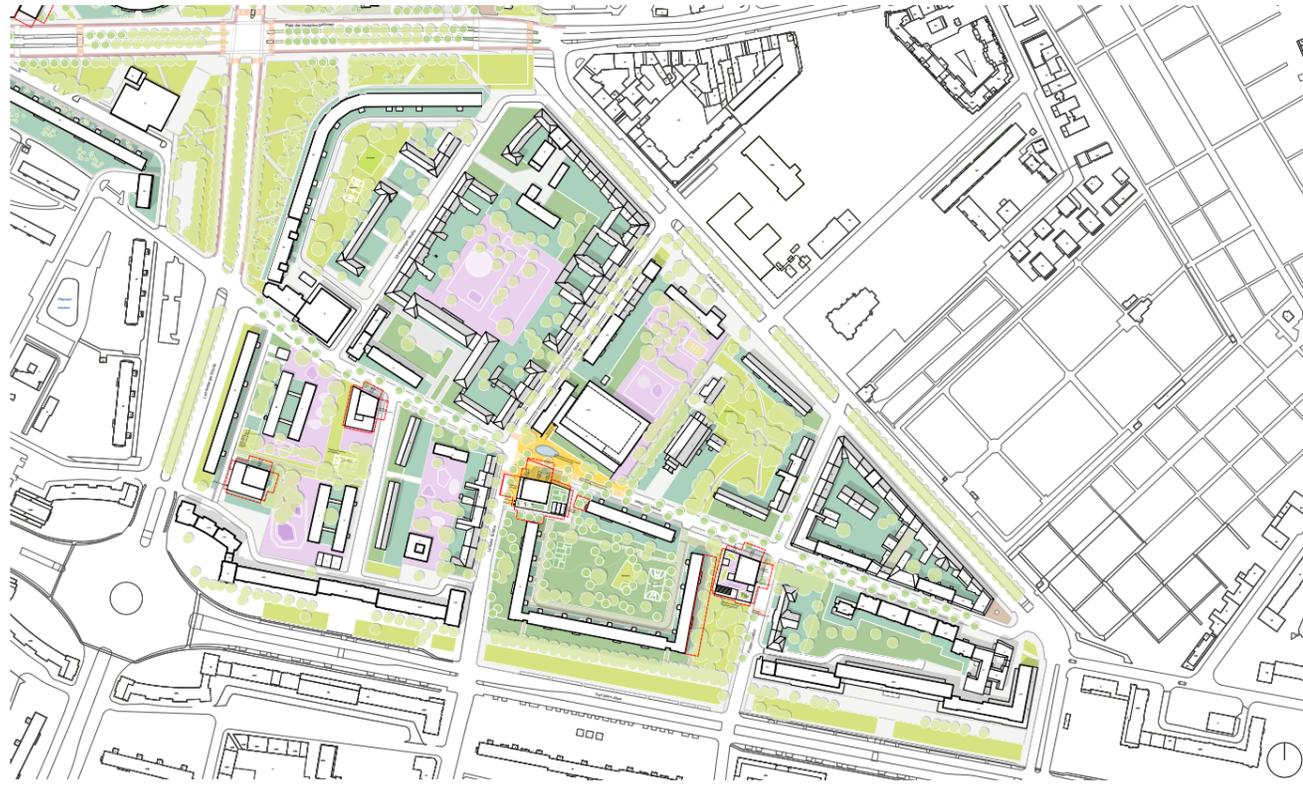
Testentwurf Friedenstraße, Stand Januar 2020
